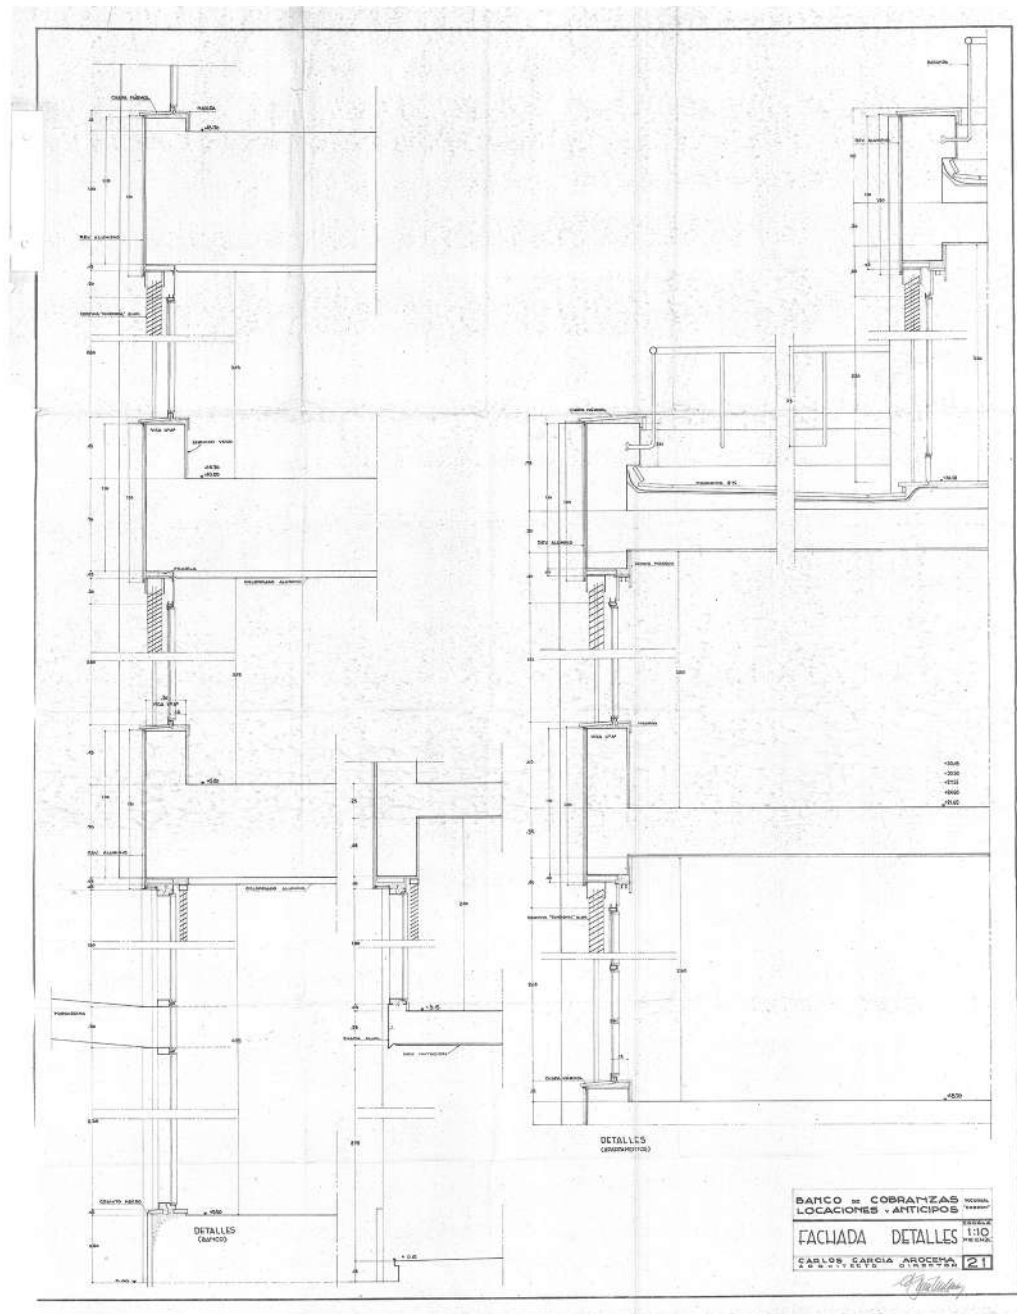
Lámina 21 del proyecto ejecutivo del BCLA: detalles en corte de fachada.
